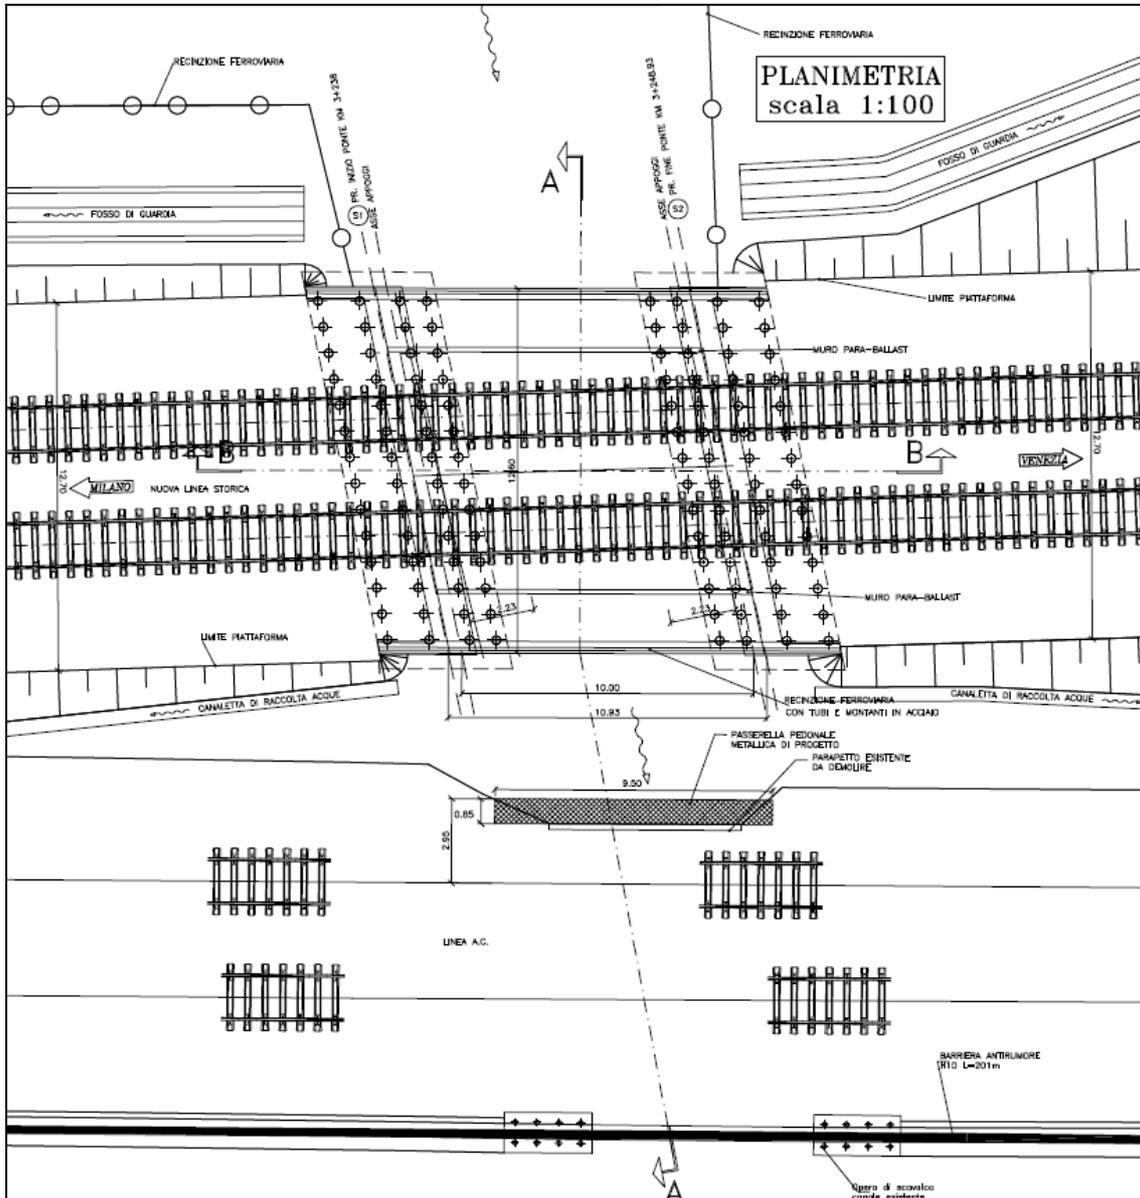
Ponte sul Canale San Giovanni – Pianta 1:100
